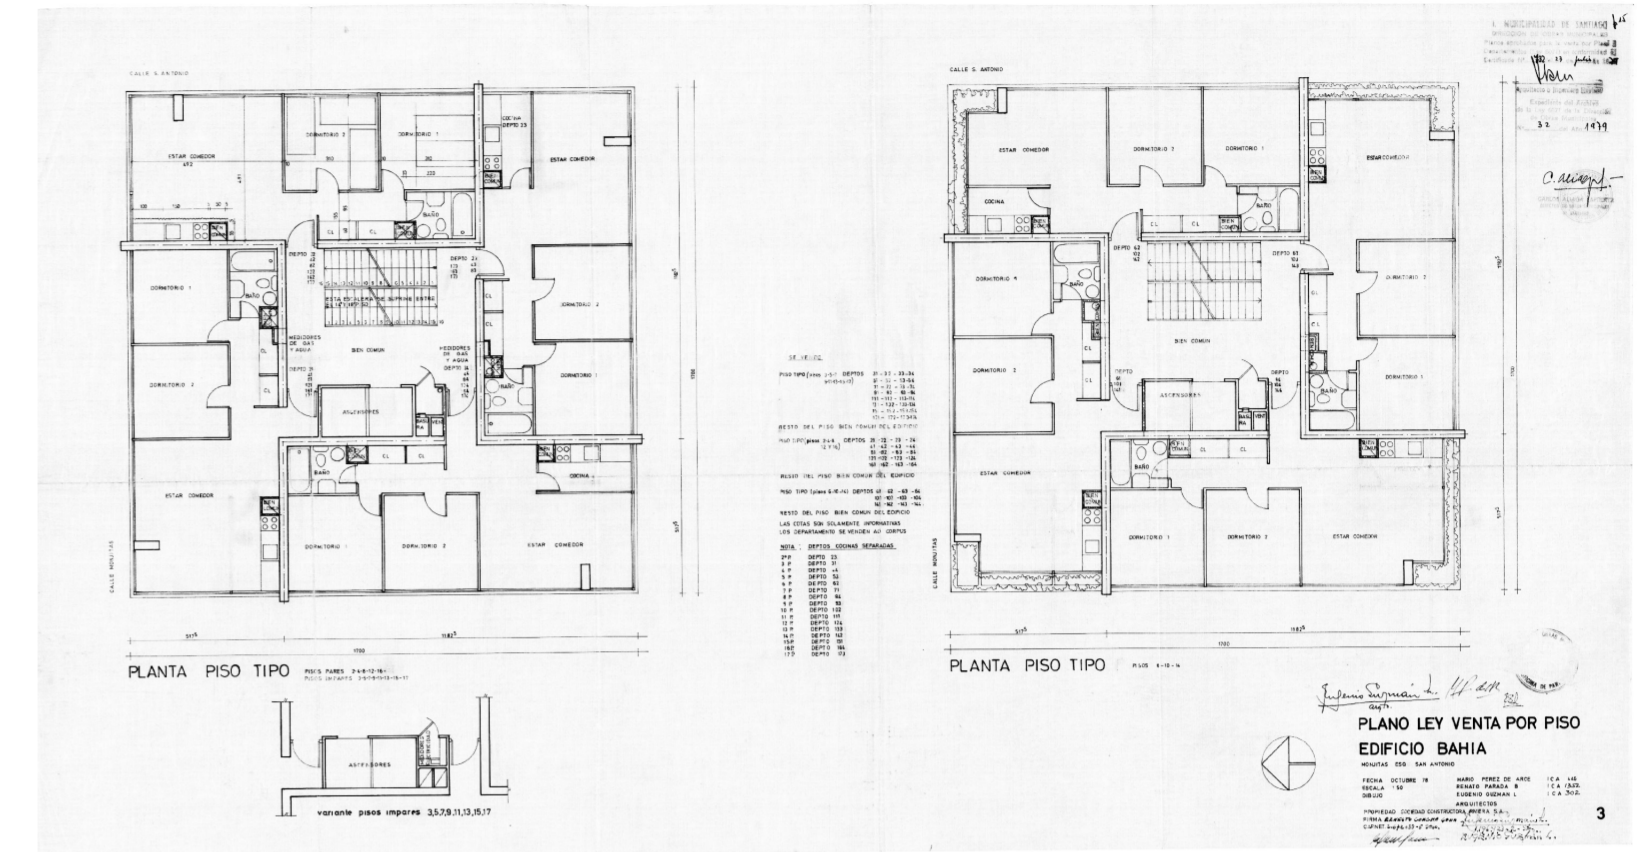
Archivo Plano Municipal. Planta tipo torre niveles pares, impares.
